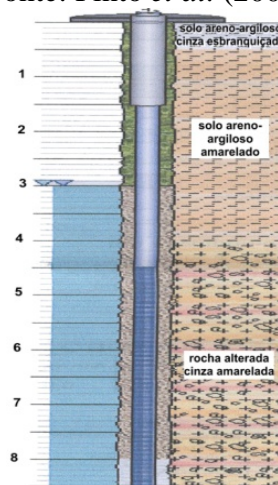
Perfil do piezômetro da Chácara São Vicente
